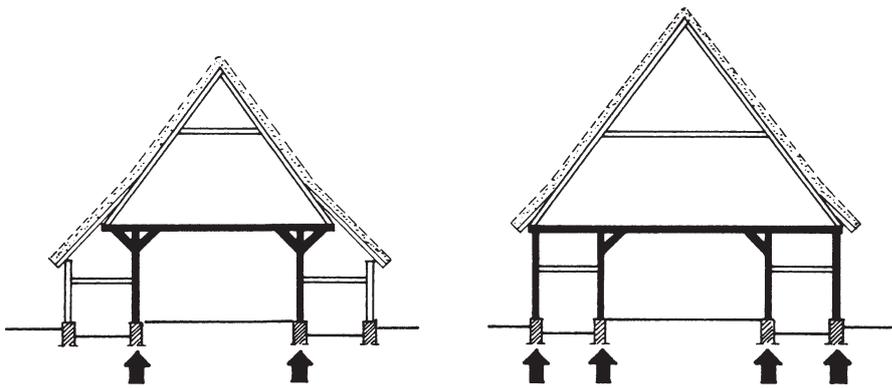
Zwei- und Vierständerbau mit Dachbalkenverzimderung
